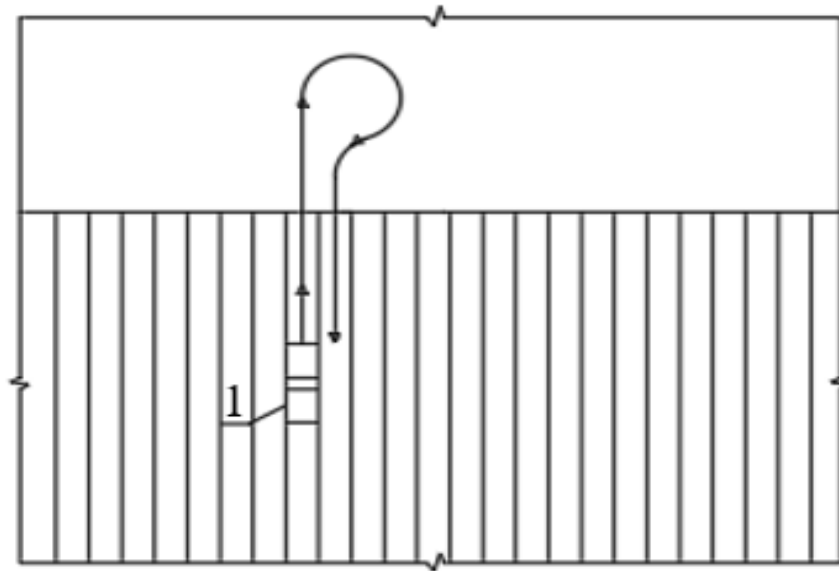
Третий вариант схемы разворота машины послойного фрезерования [123]:
